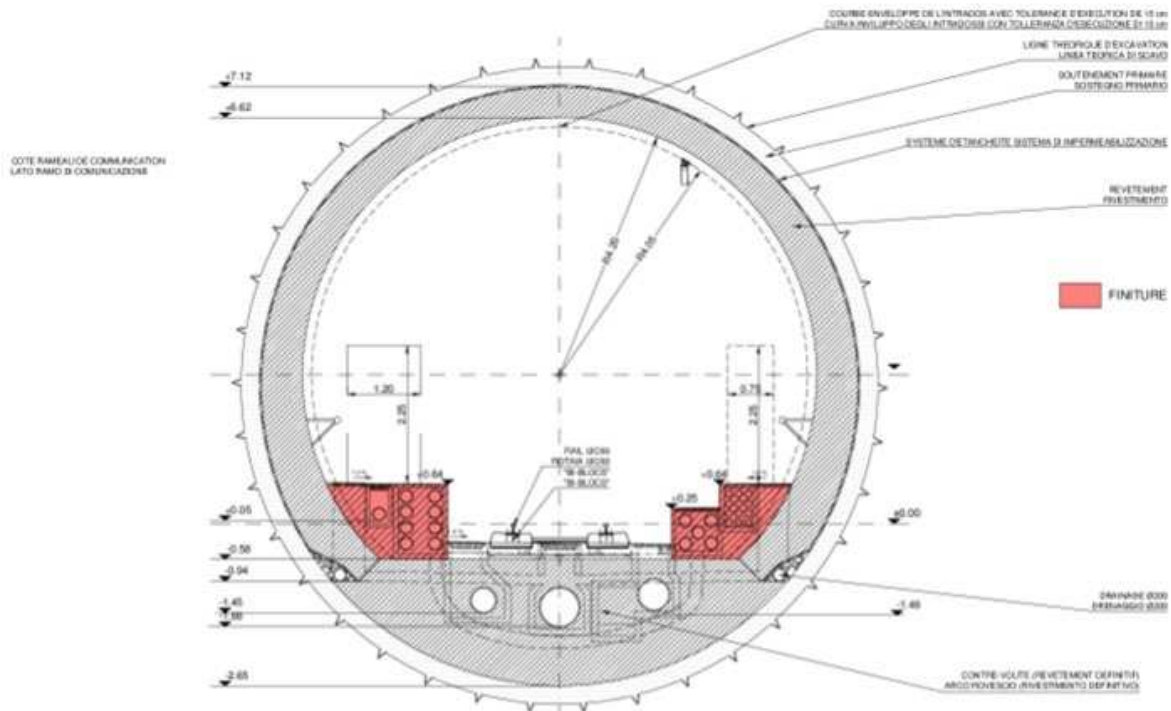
Tunnel de Base : section type descriptive de l’excavation par tunnelier ouvert
